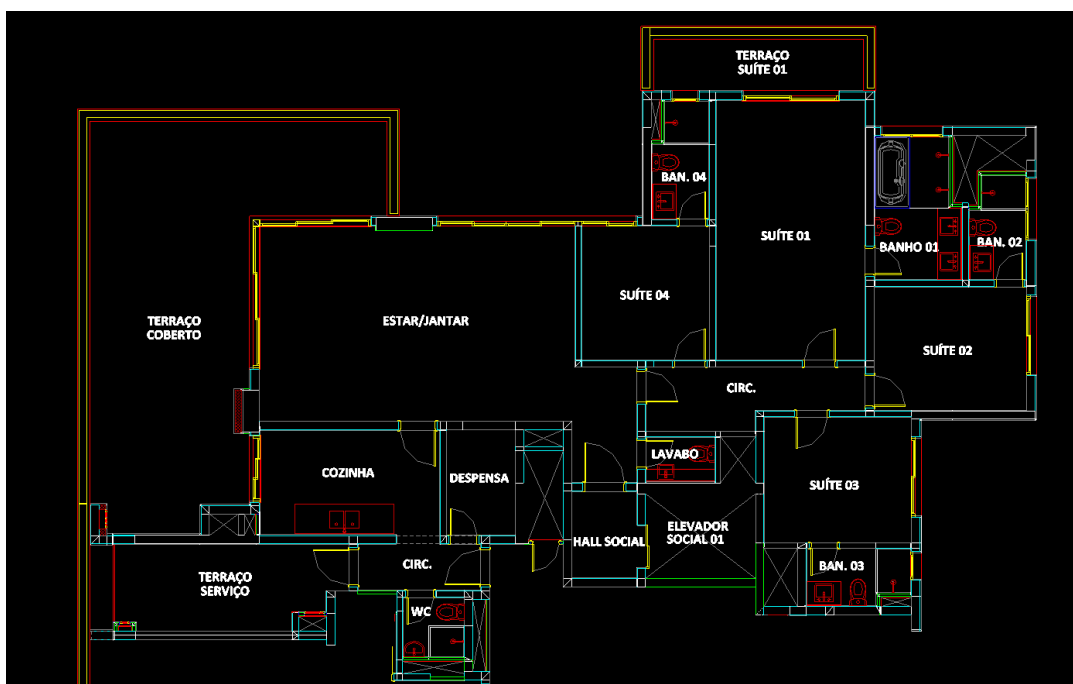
Planta Baixa dos finais 02 e 03 (Torre C)
